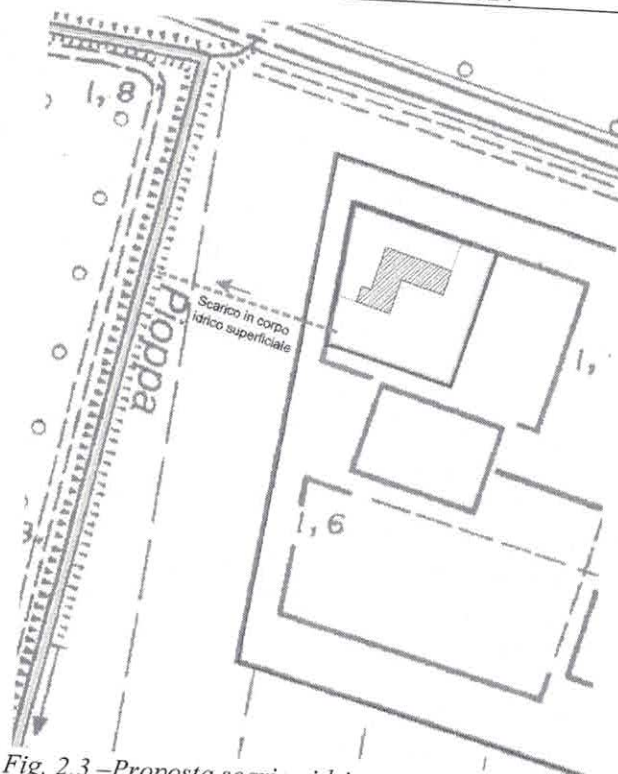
Proposta scarico idrico con rispetto Tab. 4
